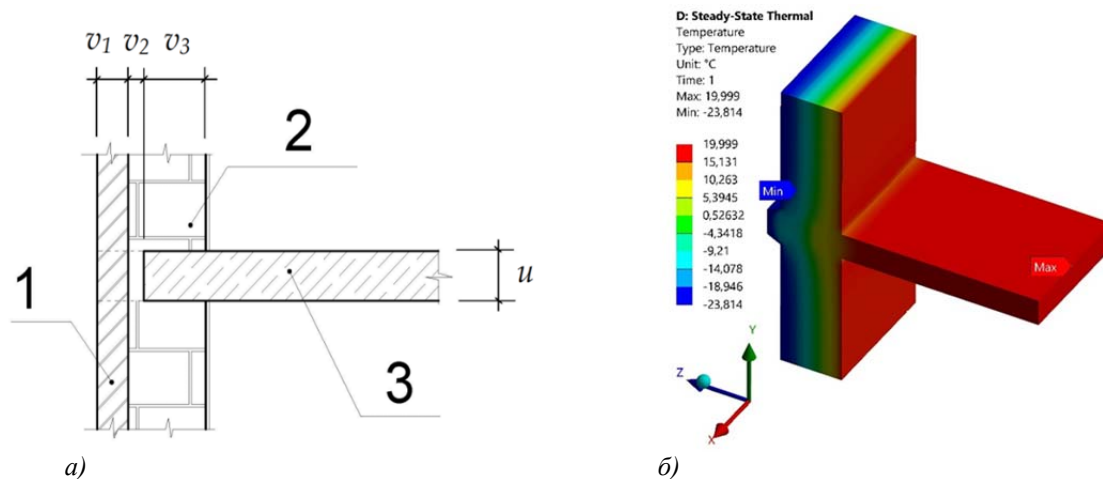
а) Конструкция базового узла сопряжения диска перекрытия со стеной (где u – толщина диска перекрытия; v_1, v_2, v_3 – толщина слоев стены; цифрами обозначены: 1 – лицевой слой кирпичной кладки; 2 – кладка из ячеистого бетона; 3 – железобетонный диск перекрытия); б) Результат моделирования температурного поля в узле сопряжения диска перекрытия со стеной, имеющем теплозащитный каркас трапециевидальной формы
